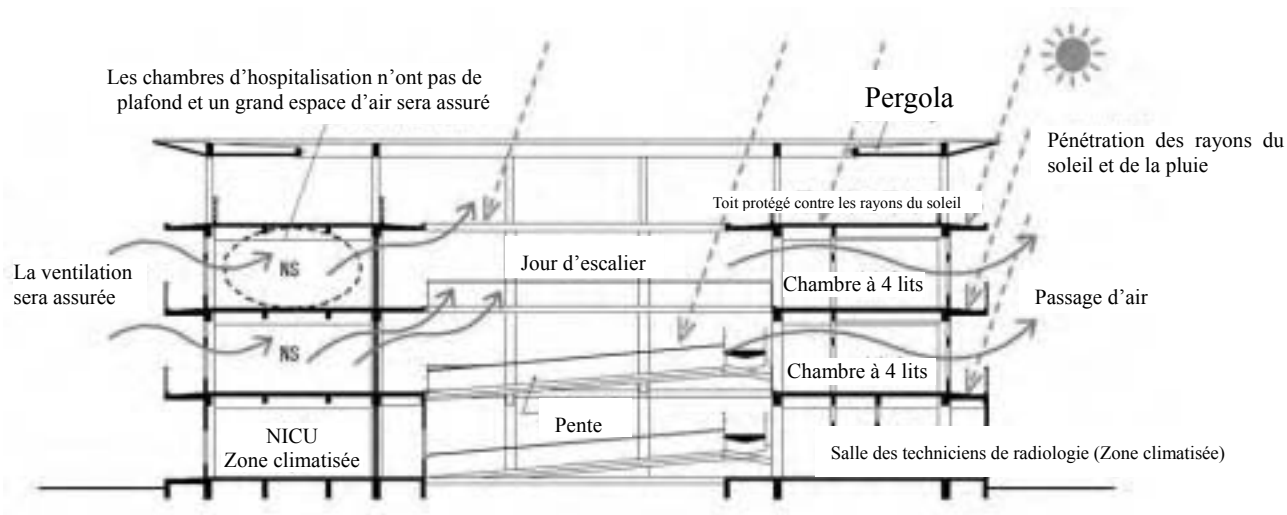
Coupe transversale du nouveau bâtiment d'hospitalisation
